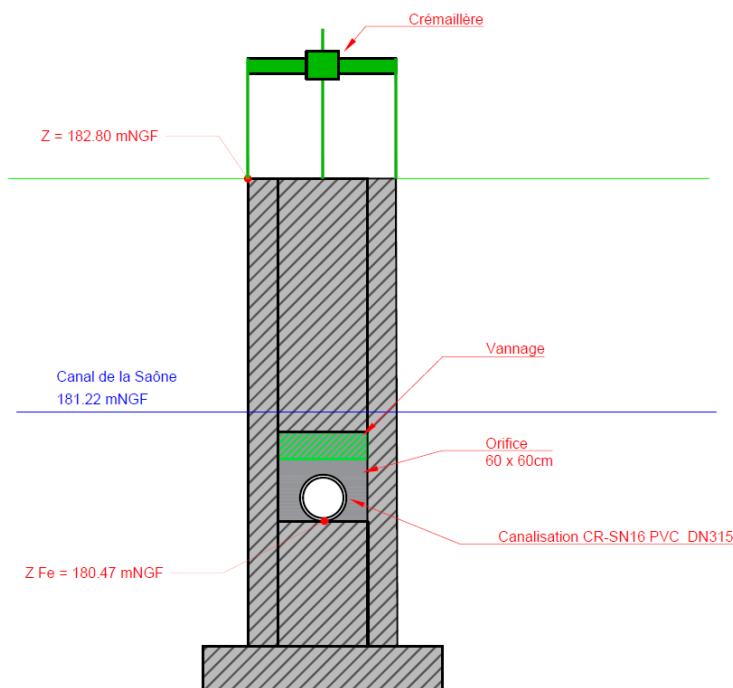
Elévation amont de l'ouvrage de prise d'eau
